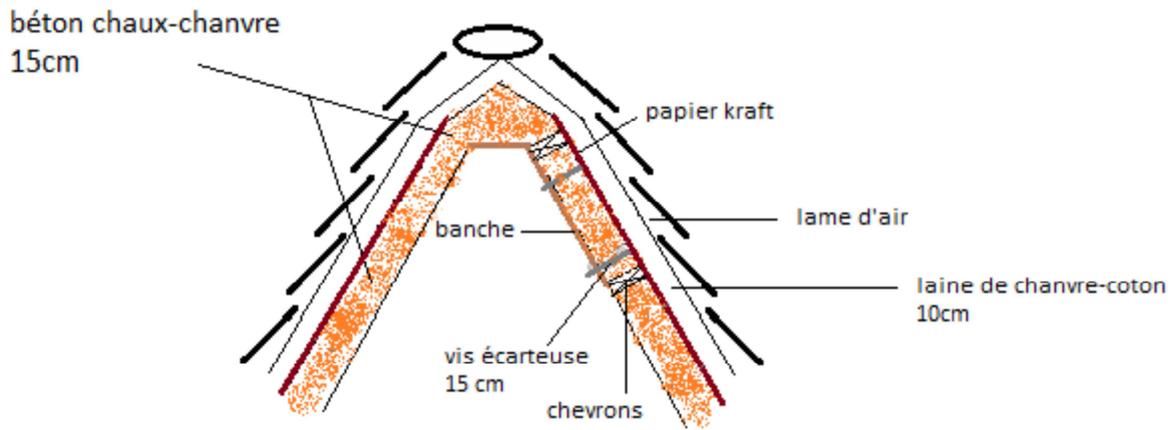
Coupe verticale de l'isolation de la toiture
